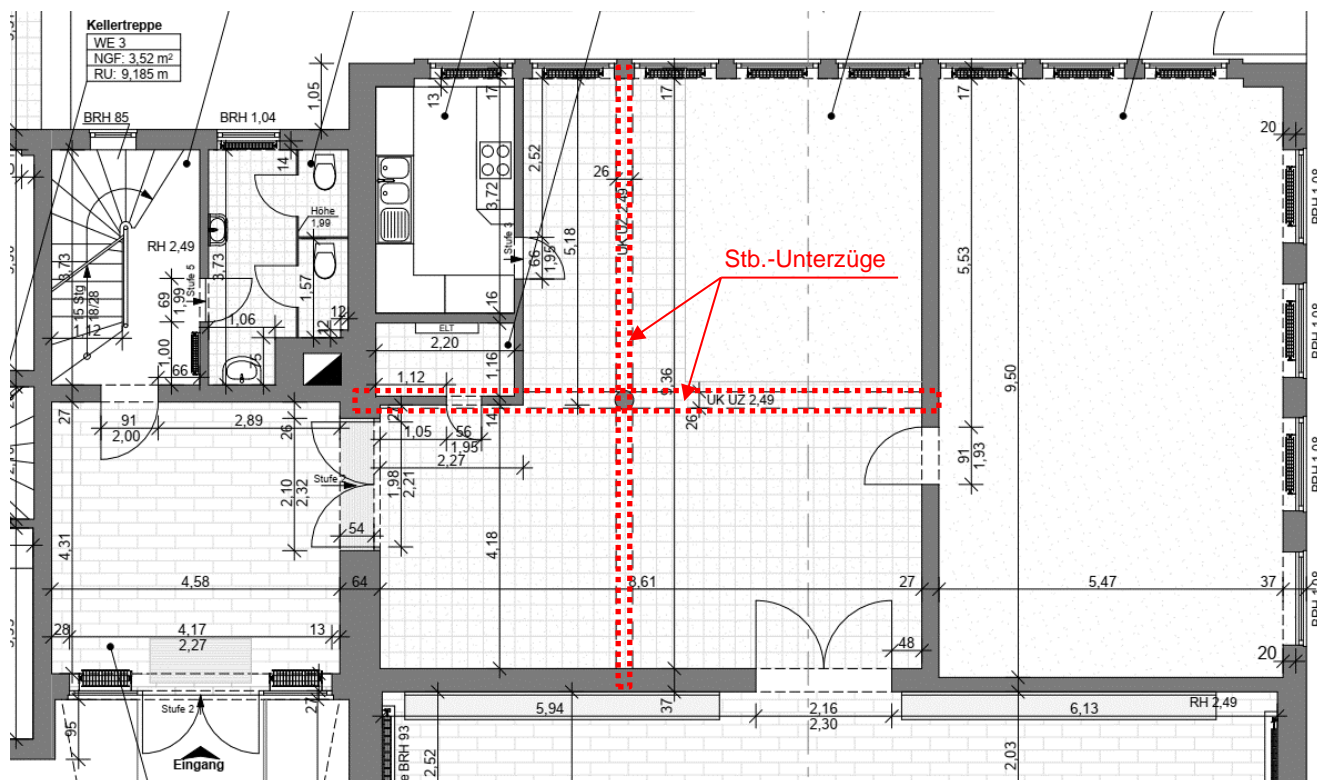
Auszug Bestandsplan [U 1] – Obergeschoss Gemeindehaus mit angrenzendem Kirchenraum, kommentiert
